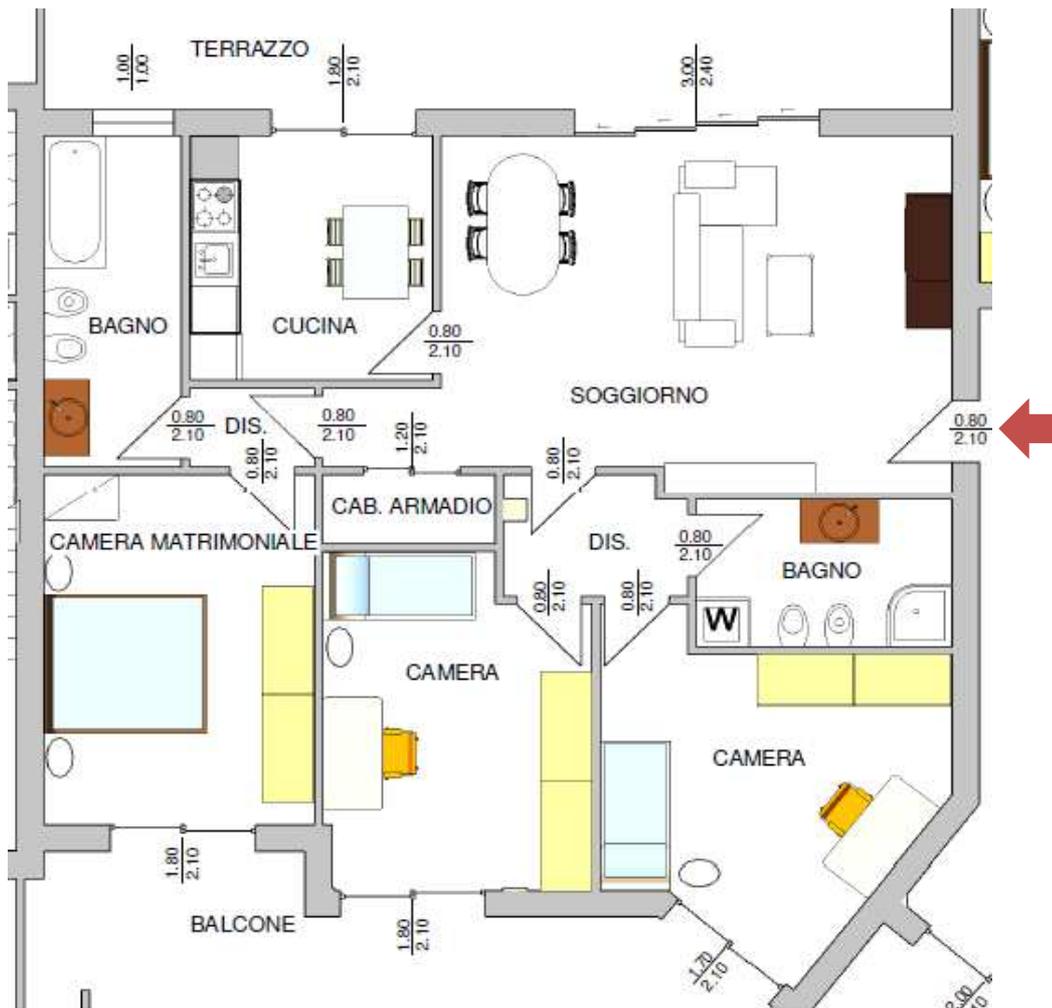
Stralcio pianta piano rialzato – Quadrilocale
